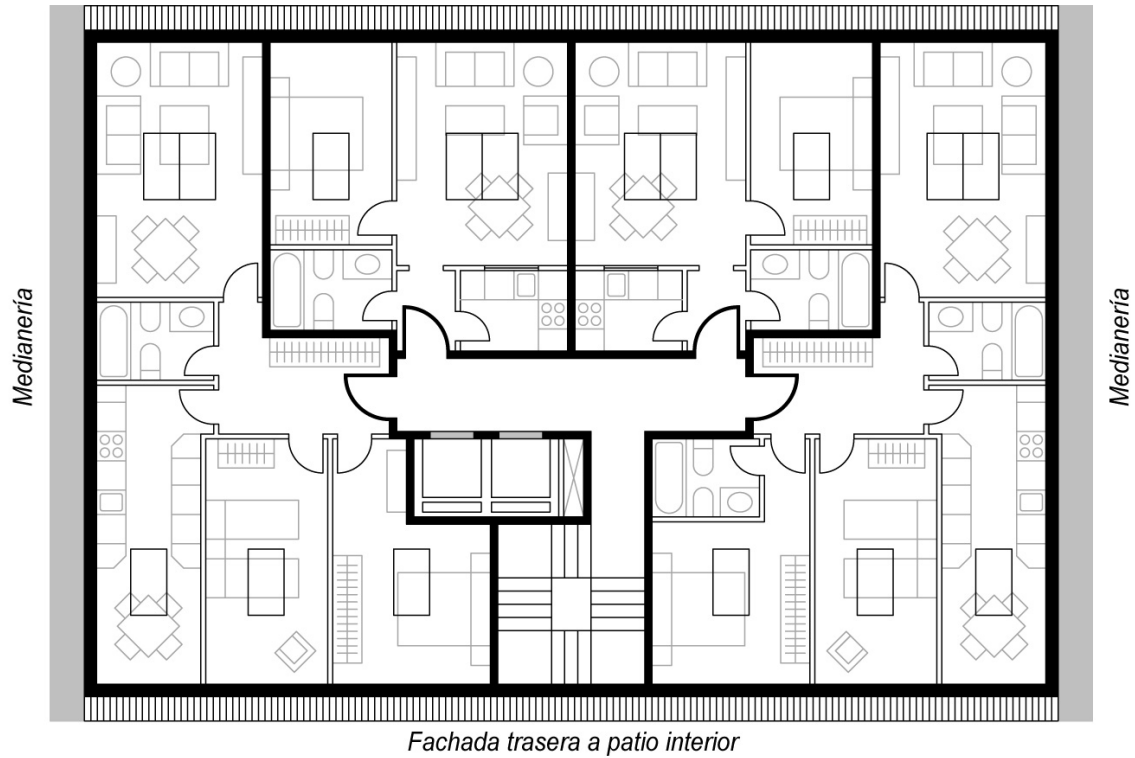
Planta tipo (1ª, 2ª y 3ª) y planta bajo cubierta.
